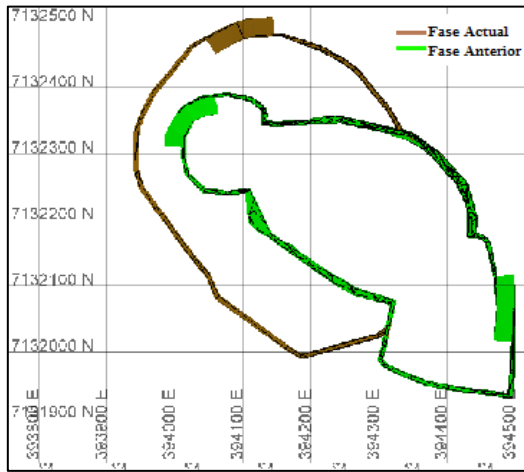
LG2Y Fase 3 - Vista en sección –Planta banco 1050
